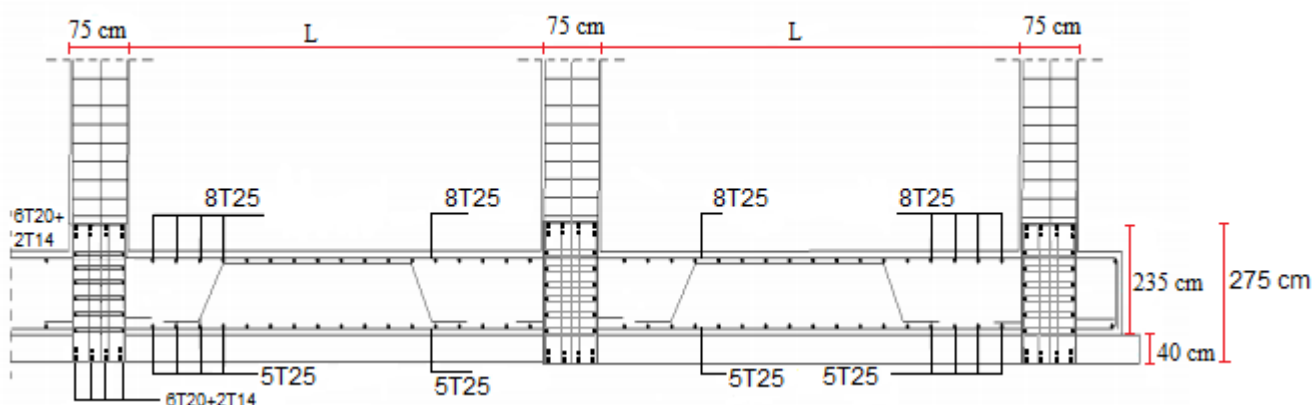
schéma de ferrailage de dalle de radier sens X-X.
